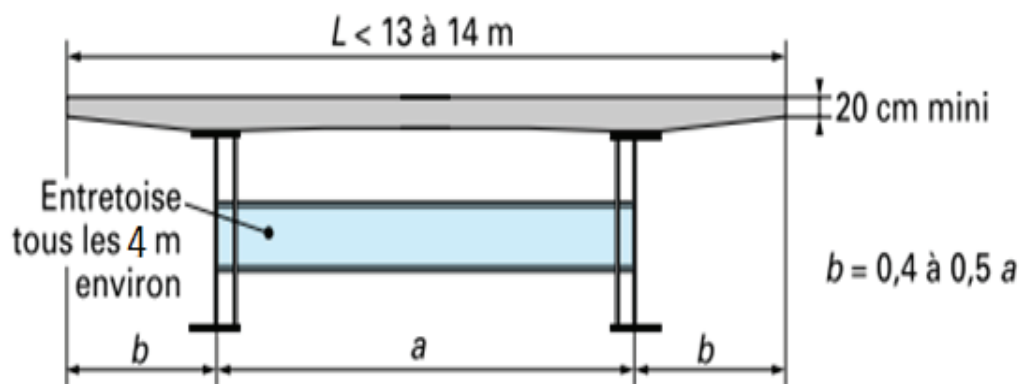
Coupe transversale d'un tablier bipoutre.
